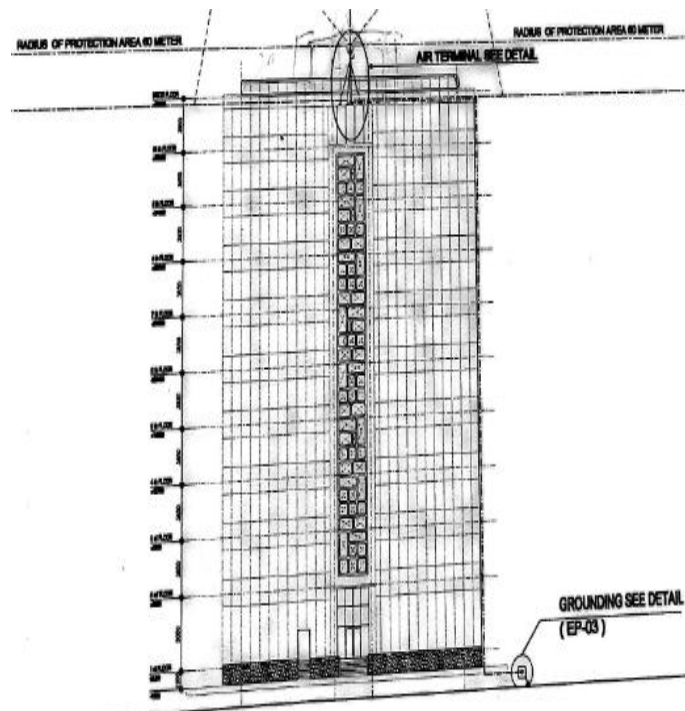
Instalasi Sistem Penangkal Petir Gedung Rektorat Tampak Depan Bangunan
